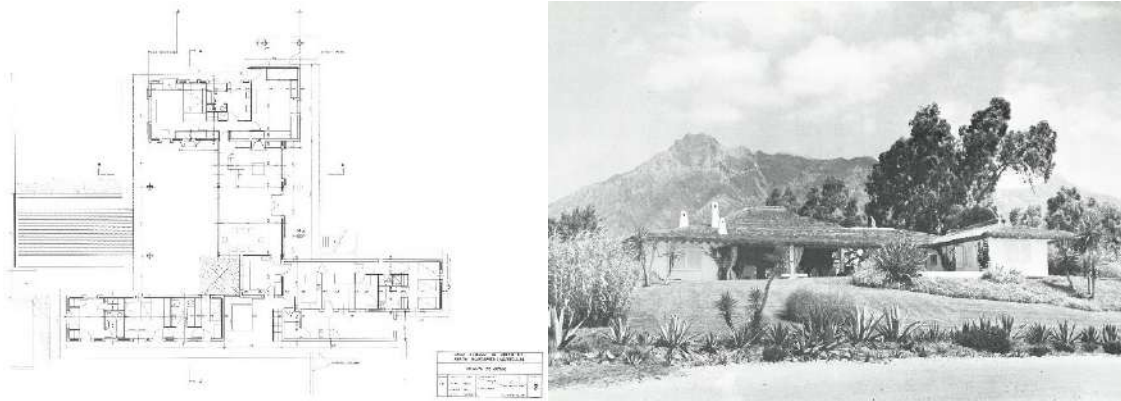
Casa duques de Arión*, Santa Margarita, Marbella, 1967-68. Planta y vista exterior. Archivo Familia Serrano-Suñer.
